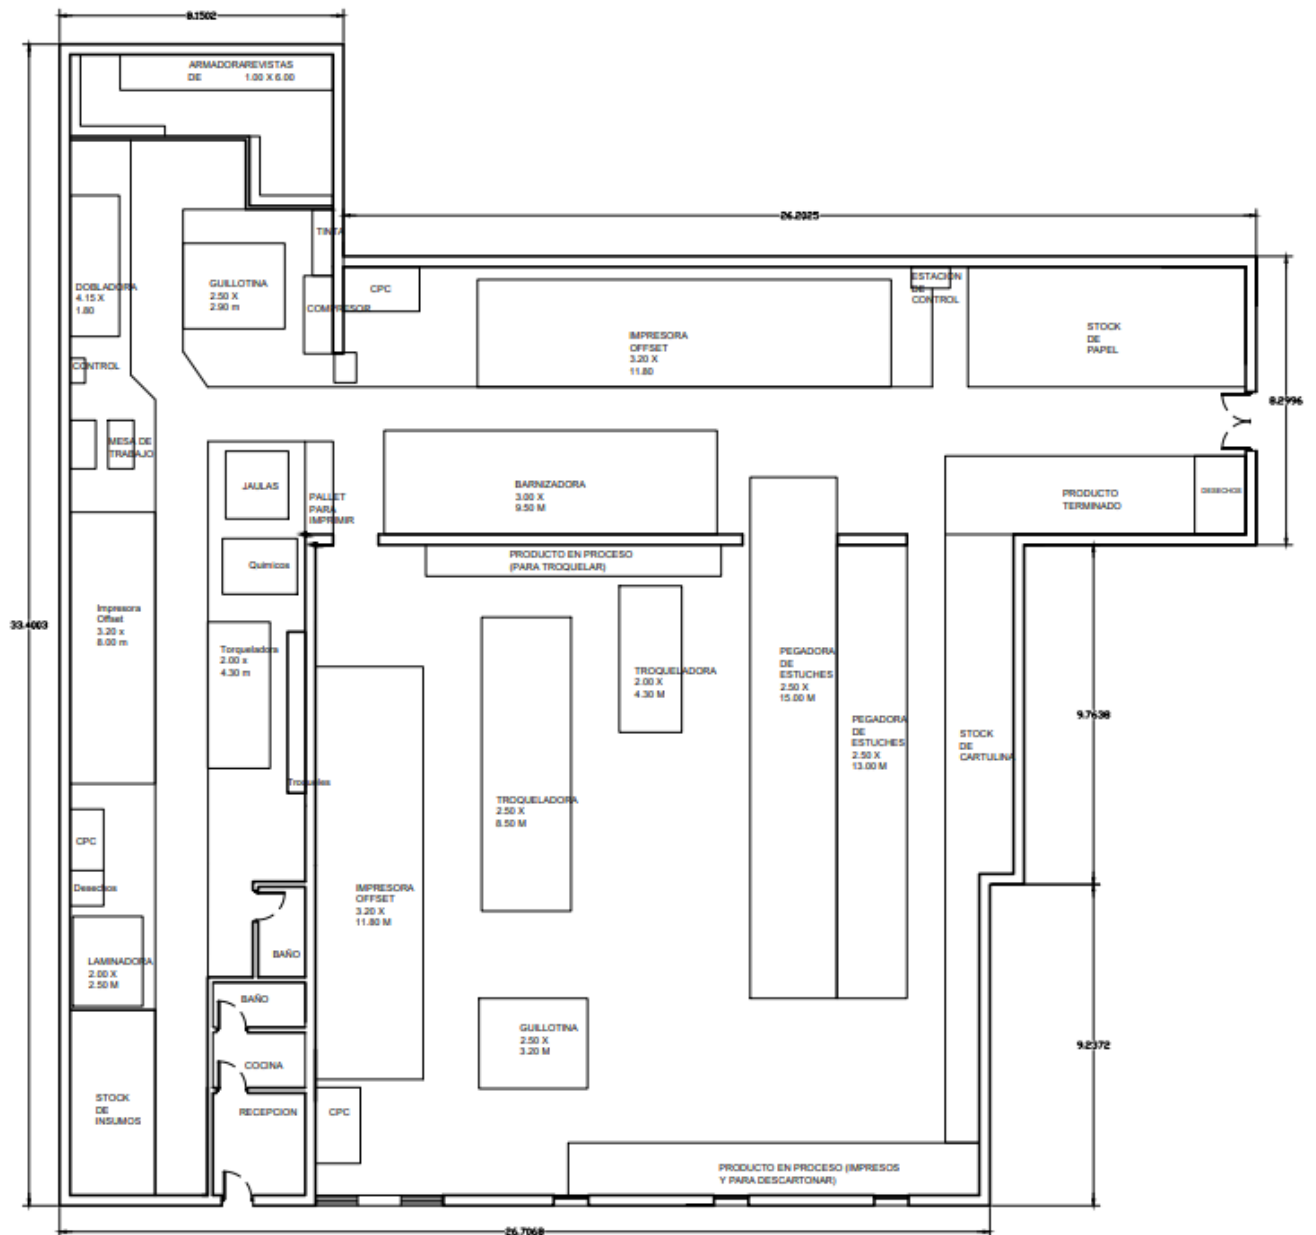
Planimetría de planta - Industrias graficas ATT
